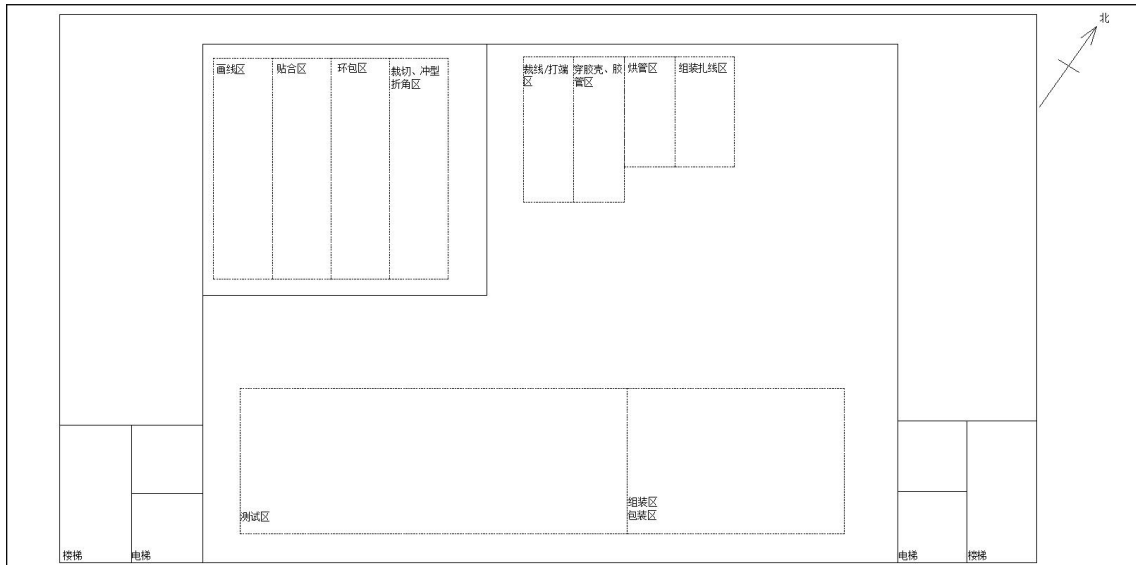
背光灯条生产车间（1号楼2F）平面布置图
